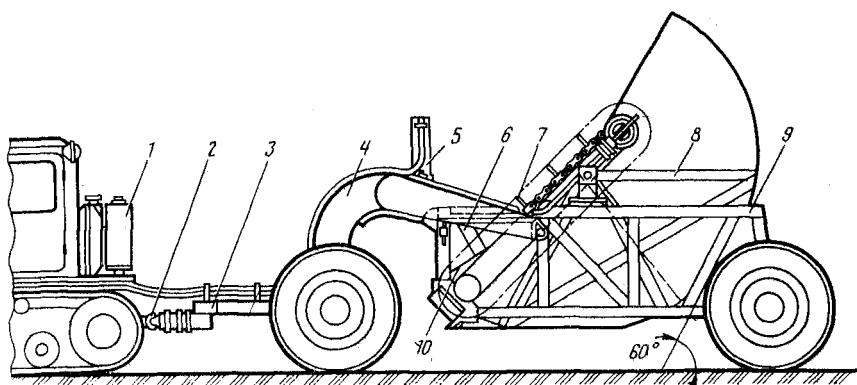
Схема скрепера ДЗ-49 с элеваторной загрузкой ковша:
